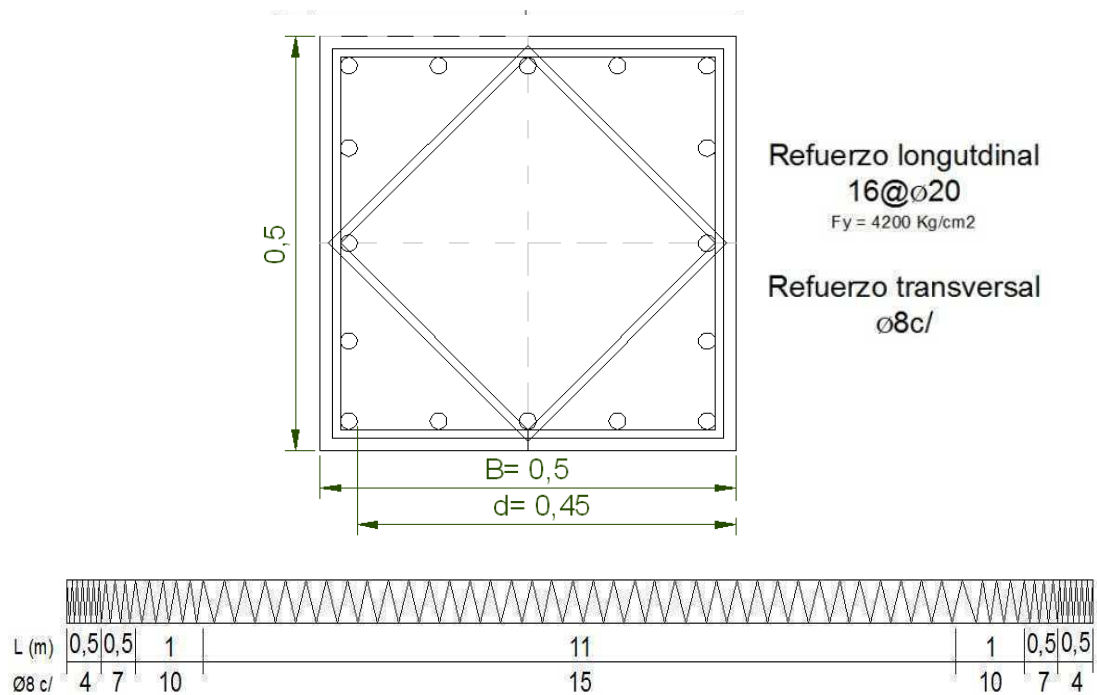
Detalle de armado estructural de tramo de pilote prefabricado de hormigón reforzado descrito en modelo estructural
